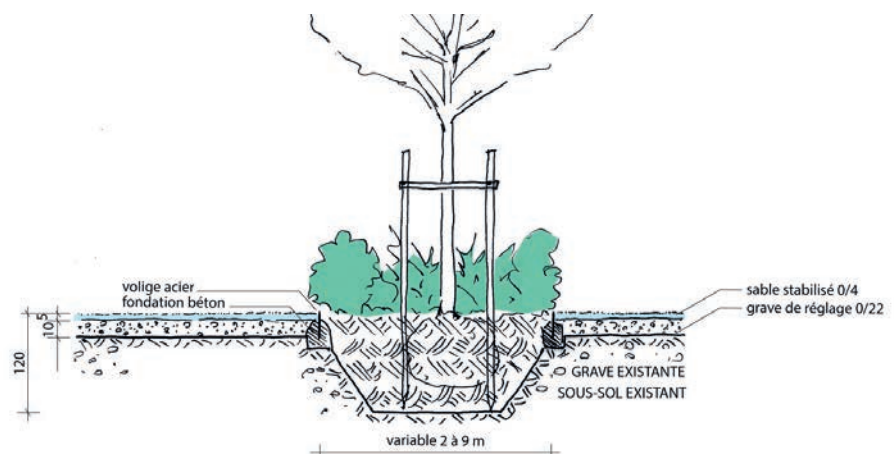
Place Pré-l'Évêque, coupe fosse et revêtement. dessin: SEVE/E. Amos & B. Goyard
